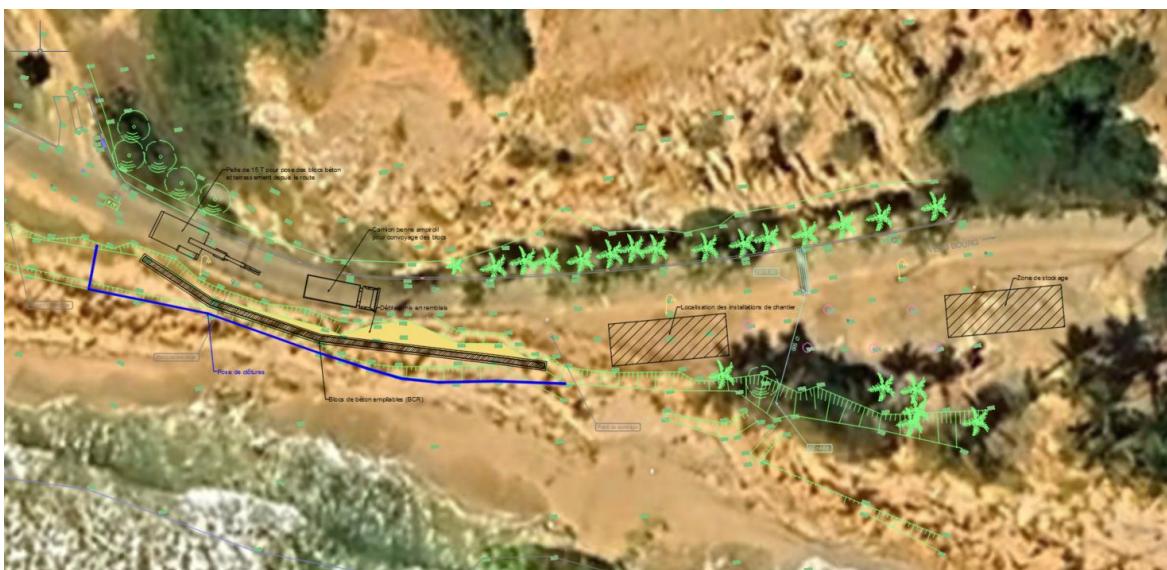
Plan des installations de chantier (Source : Suez Consulting)
